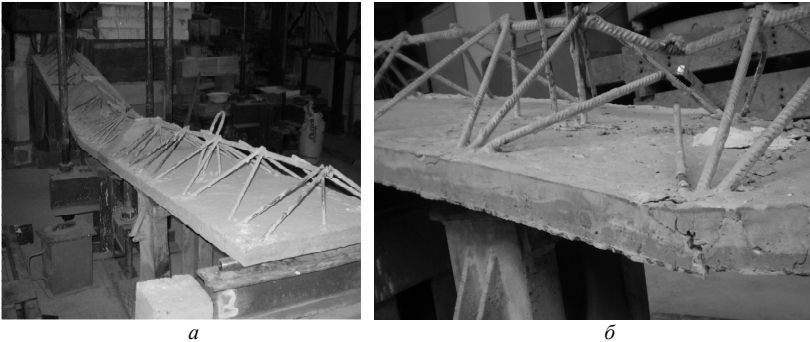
Вигляд опалубкових залізобетонних плит після випробування:
